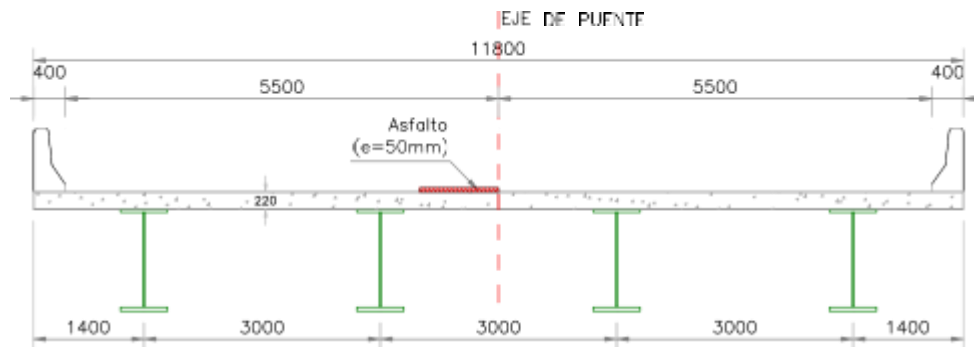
Sección transversal de la superestructura del puente del ejemplo 1.
